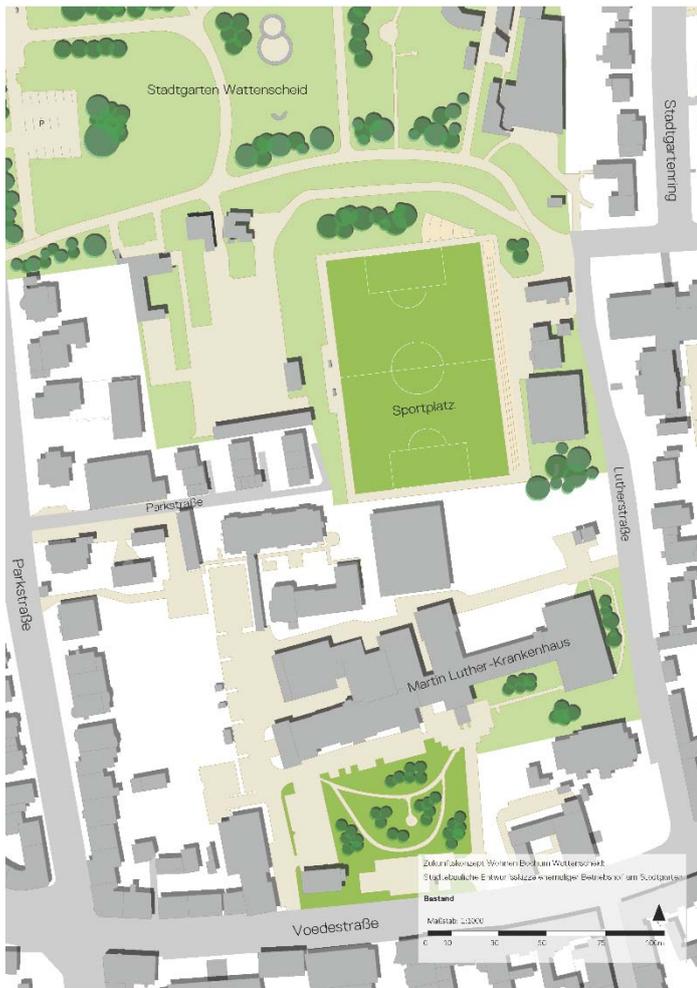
Lageplan Bestand des Betriebshofgeländes
